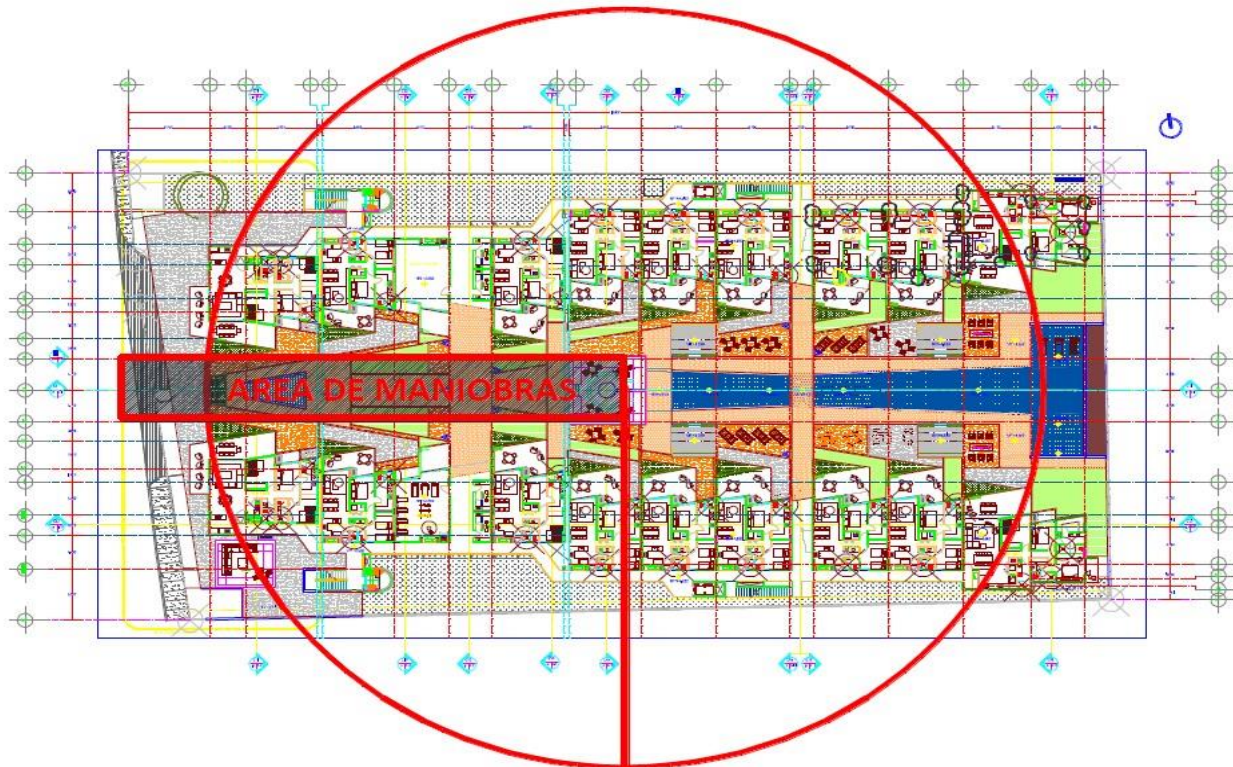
Área de maniobras del proyecto (rectángulo central en rojo).
